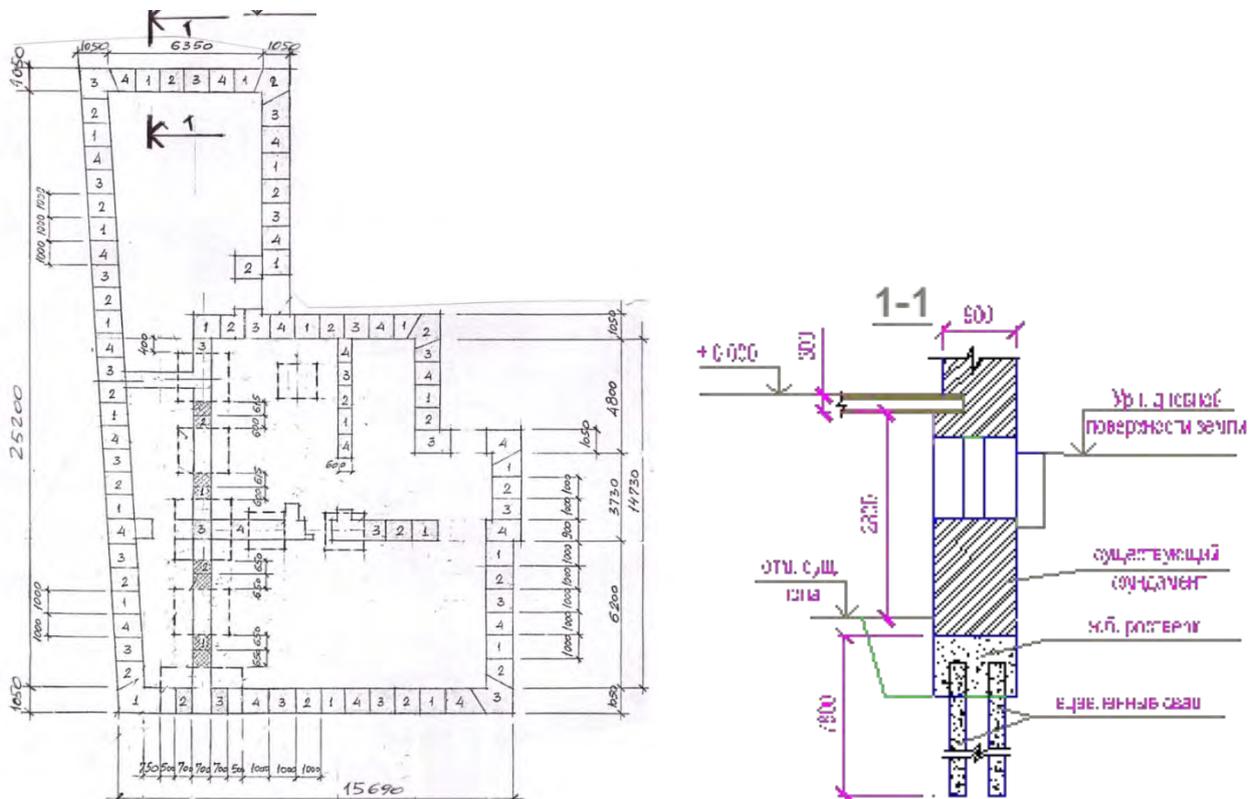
Схема разбивки фундаментов на захватки при устройстве вдавливаемых свай
